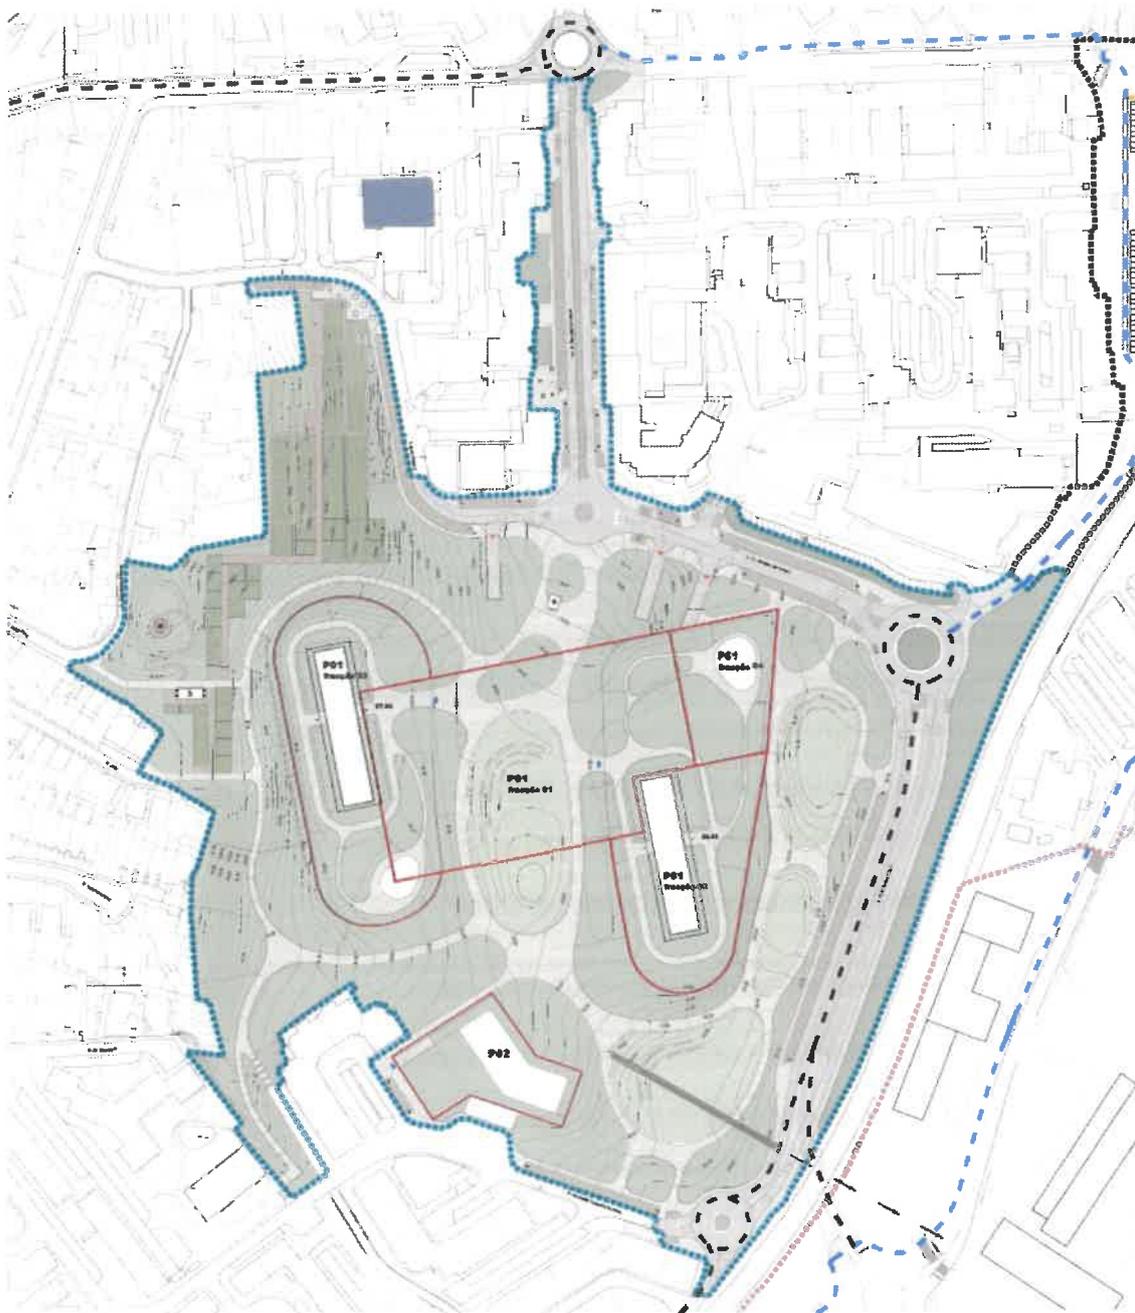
Planta de Síntese da Unidade de Execução Moinho das Antas.
